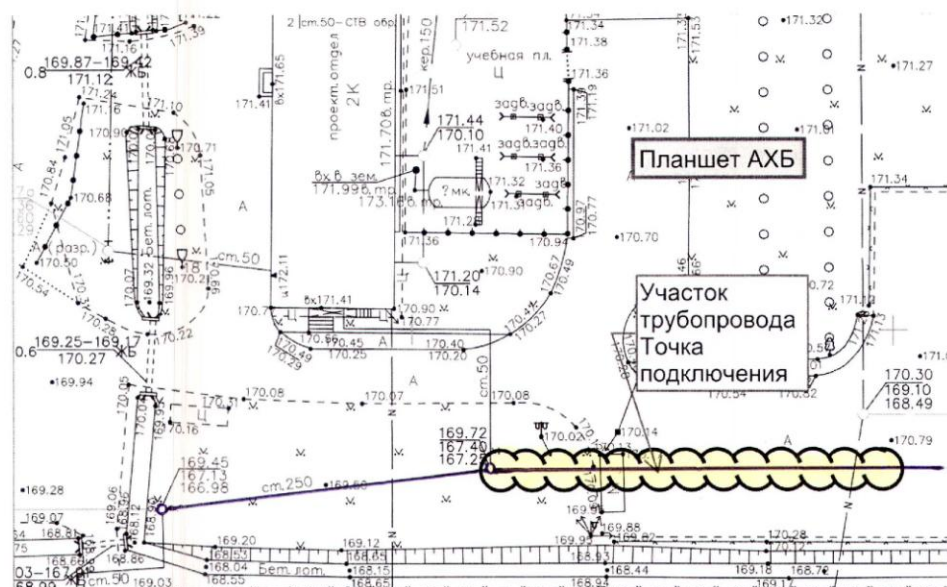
Схема подключения к сети ХПВ на планшете АХБ.
